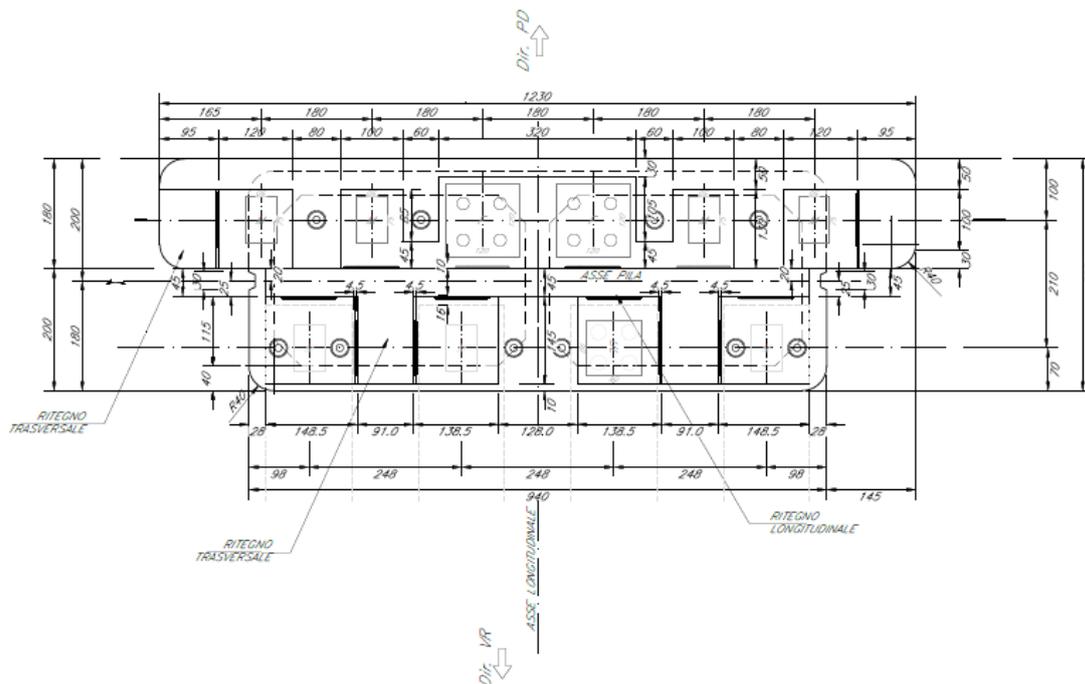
Pianta pulvino e schema appoggi (Allineamento fisso lato impalcato in Misto)
